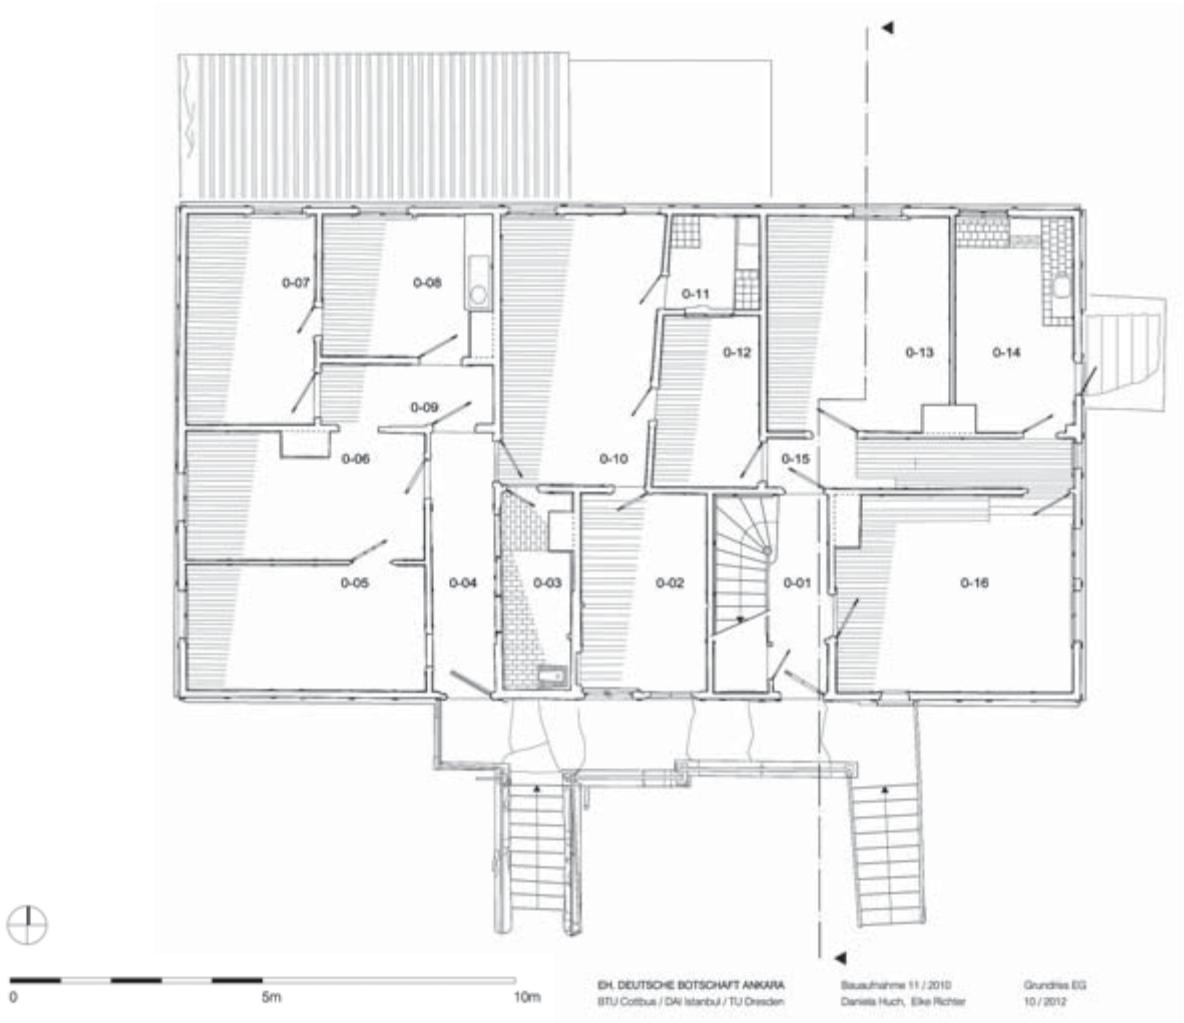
Ankara, eh. Deutsche Botschaft, Grundriss Erdgeschoss, Bauaufmaß 2010
